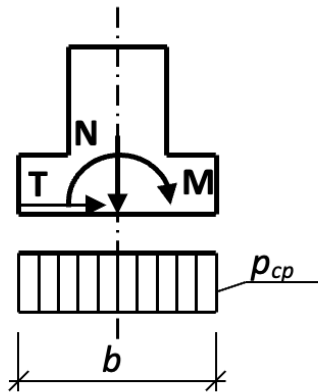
До перевірки напружень під підшвою центрально – напруженого фундаменту
